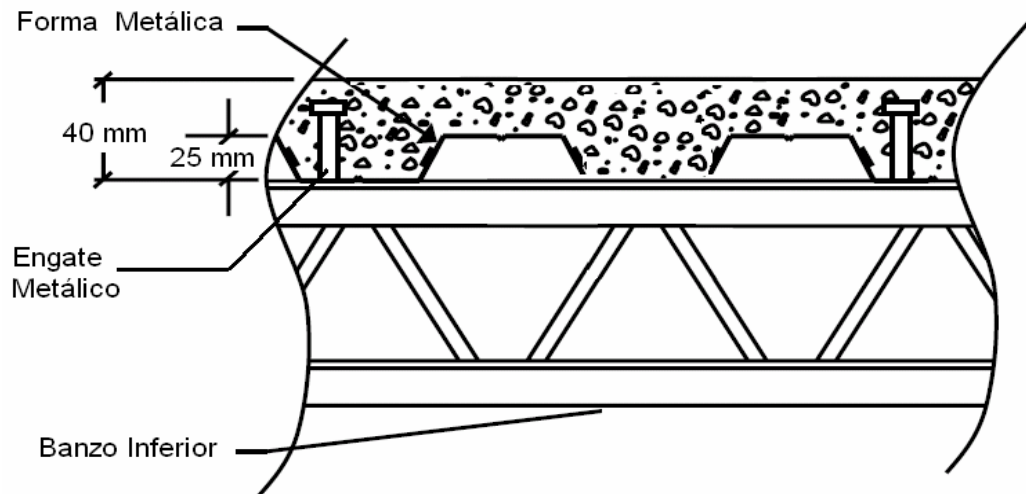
Detalhe de uma viga treliçada (joist) [59]
